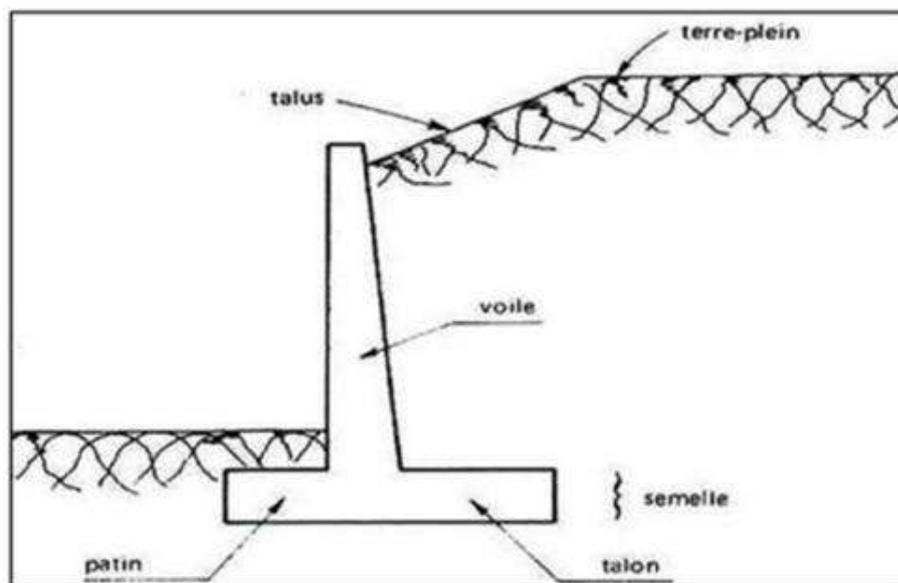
Schéma des murs du futur projet (source : SYSTRA)
